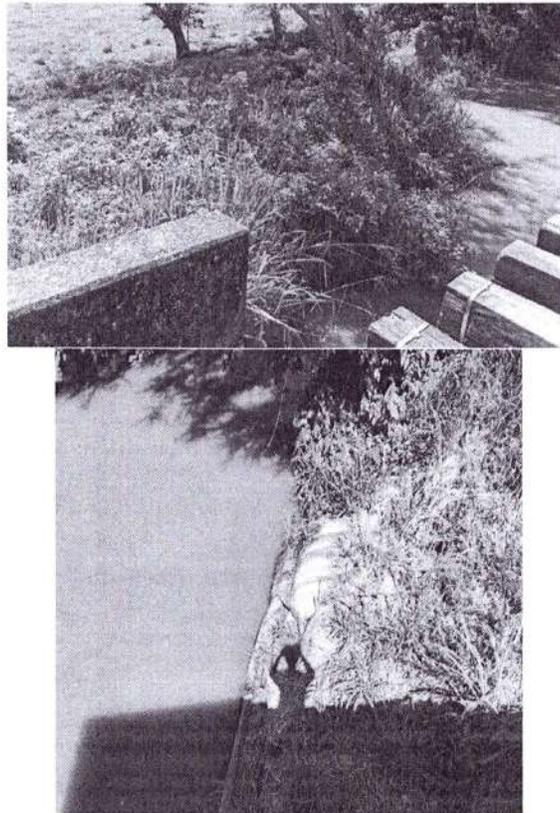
Estado ANTES de la ejecución de las obras en el abscisado férreo PK 528+871 - Puente El Hoyo
